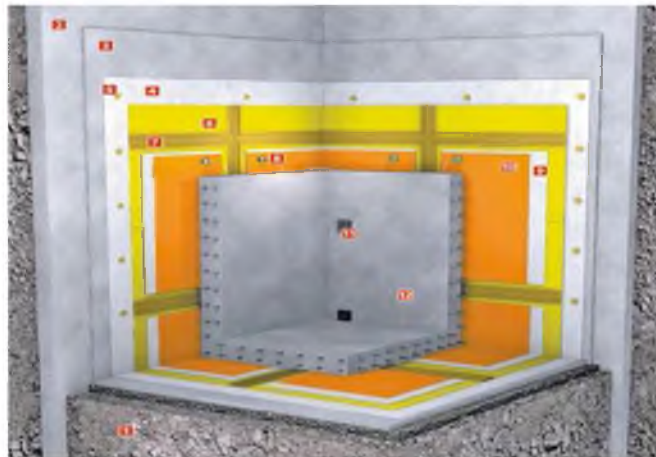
Компоненти системи ТН-ФУНДАМЕНТ Стандарт: 1 – ґрунт зворотної засипки; 2 – профільована мембрана PLANTER standard; 3 – гідроізоляційний шар, мастика ТЕХНОКОЛЬ №21 (Техномаст); 4 – фундаментна плита; 5 – праймер бітумний ТЕХНОКОЛЬ №01
